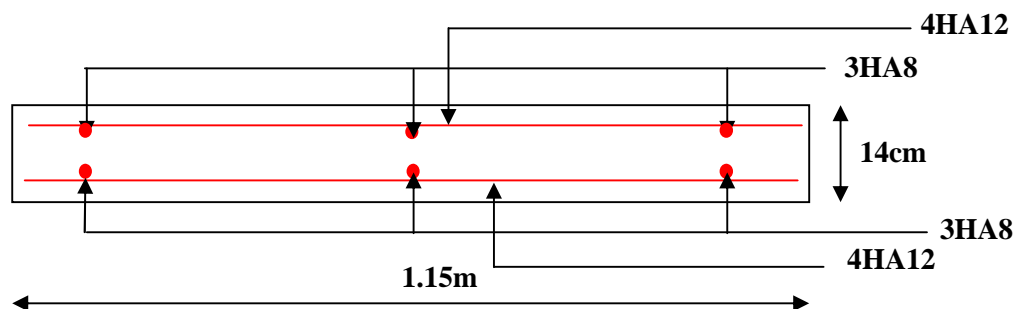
Schéma de ferraillage de la dalle pleine type N°2.
